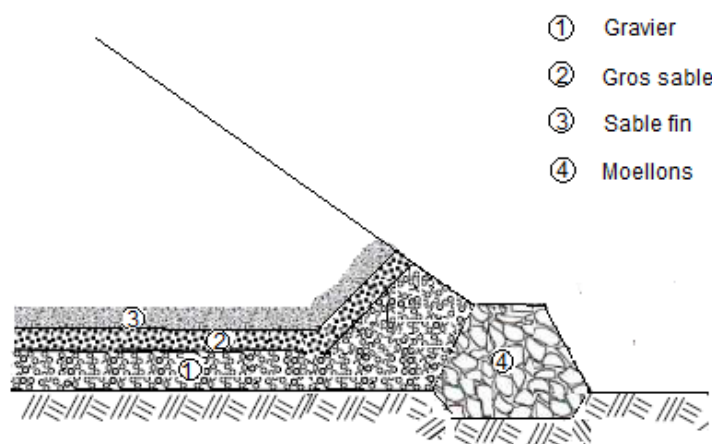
Disposition du drain et du filtre (fondation imperméable)
